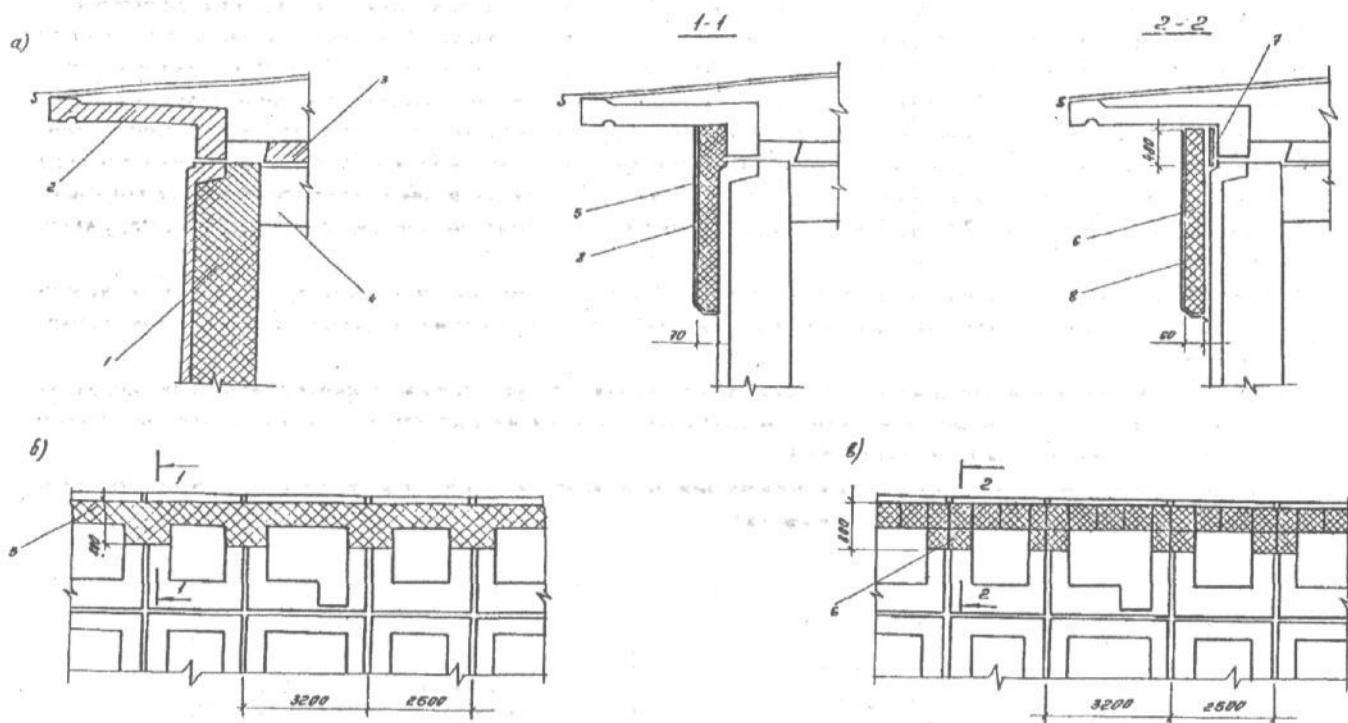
Утепление стеновых панелей в зоне карнизного блока с наружной стороны.
